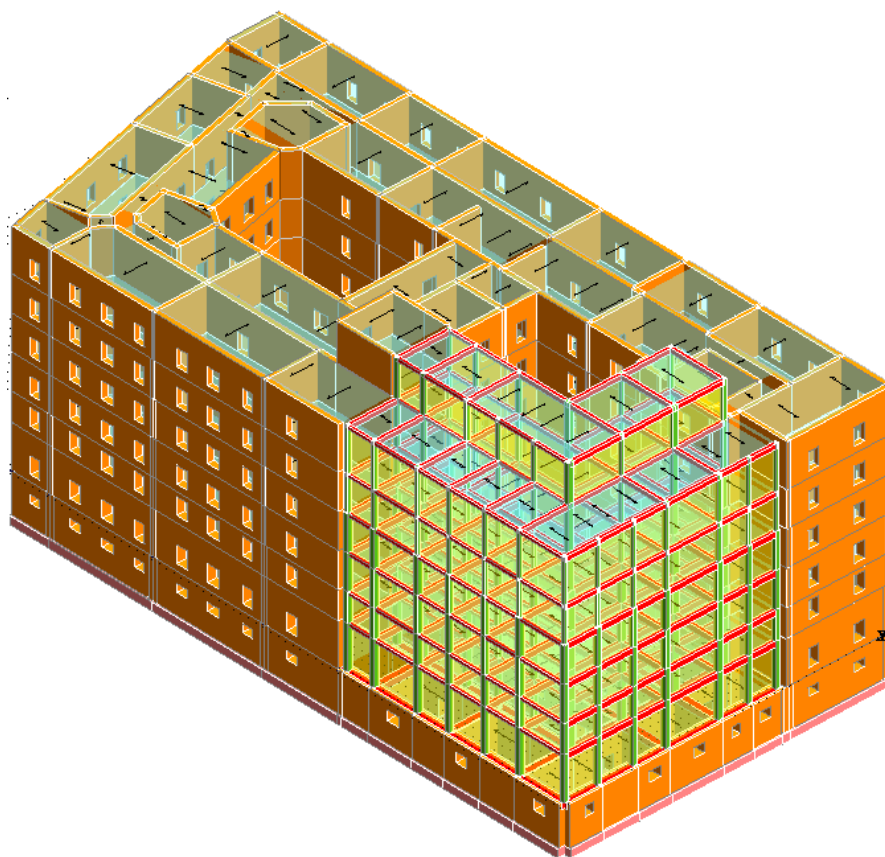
Ricostruzione tridimensionale dell'edificio
